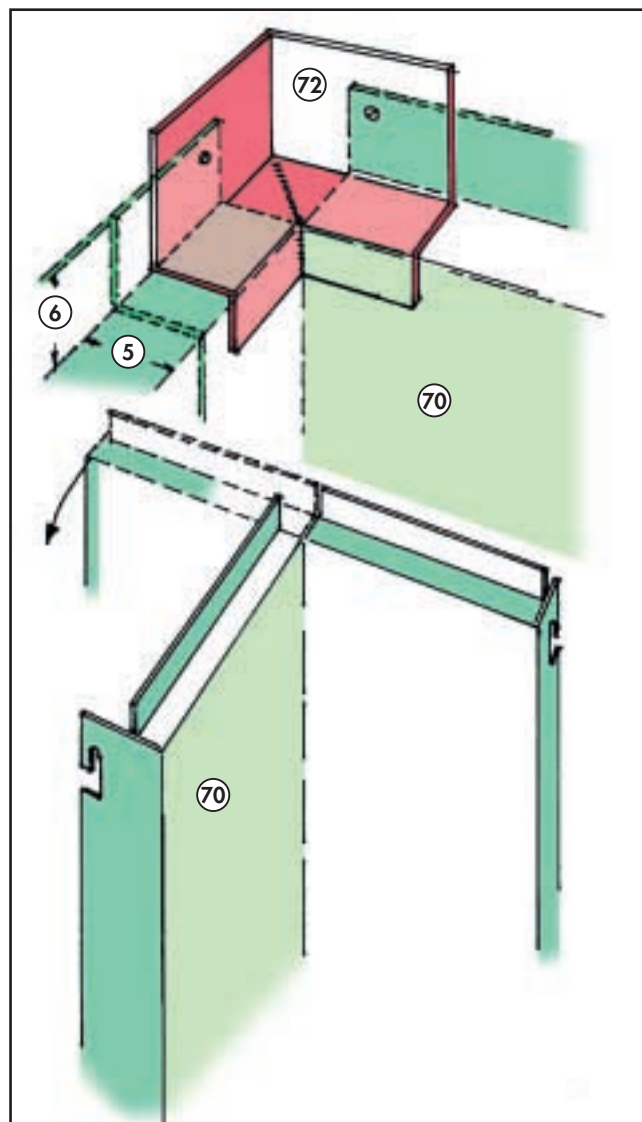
a) - Prospetto dell'estremità superiore dell'angolo rientrante, con chiusura d'angolo (72) fissata mediante viti
